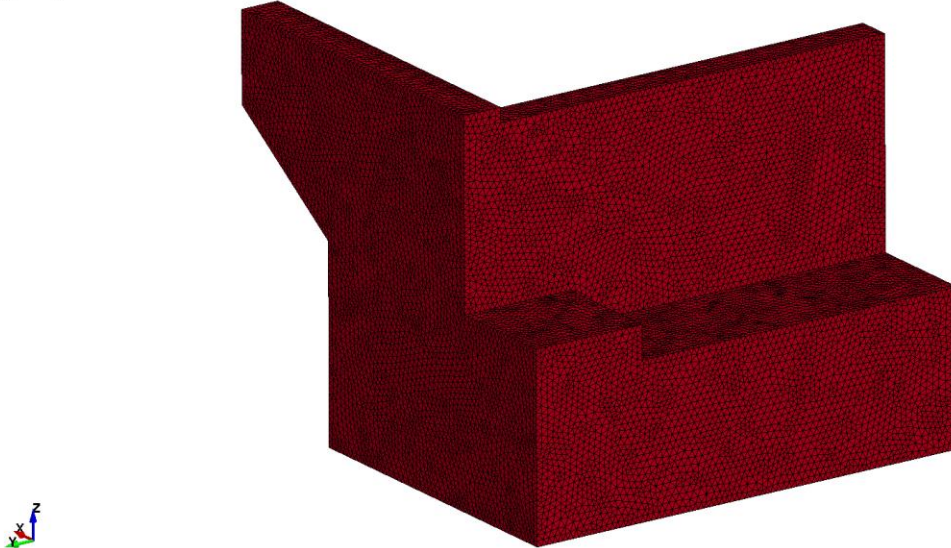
Vista de Hormigón en Modelo Estribo Completo de Puente Águila Norte.
